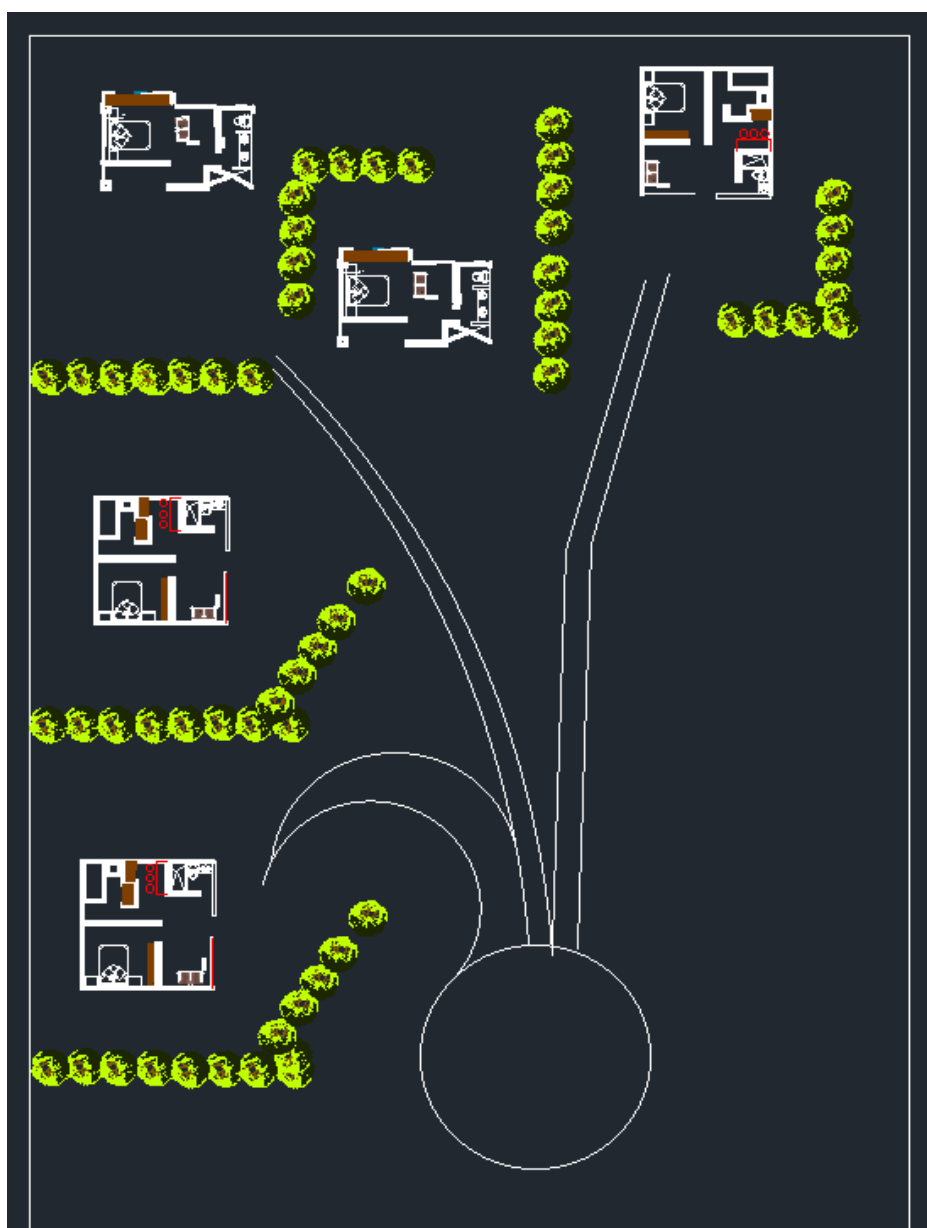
Planta arquitectónica cabañas ecológicas.
